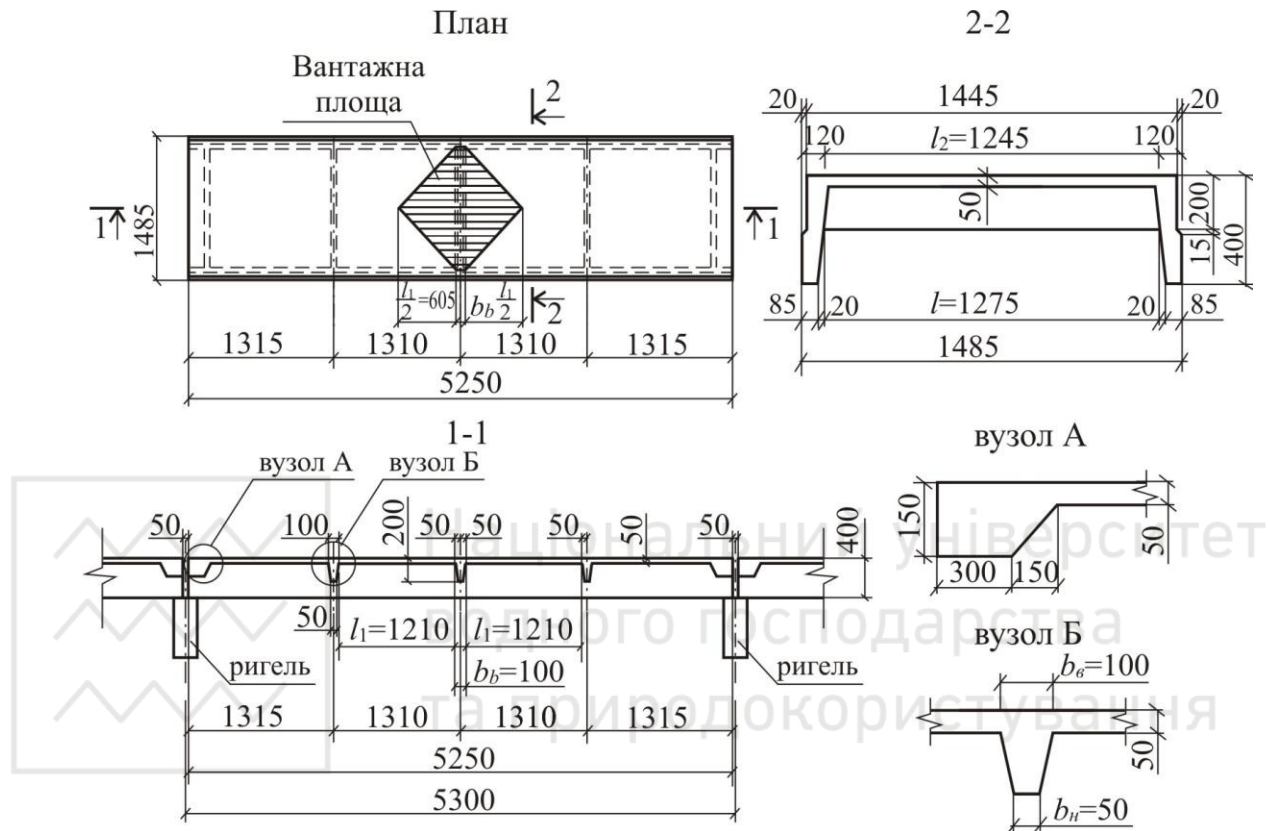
План, поздовжній і поперечний перерізи плити.
